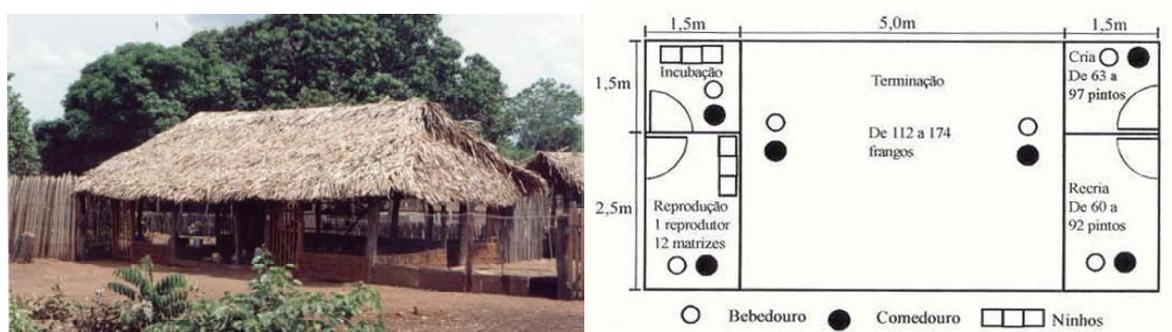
Instalação e planta baixa, recomendada para o sistema alternativo de criação de galinha caipira. Comunidade de Regeneração, Pi, 2002.
